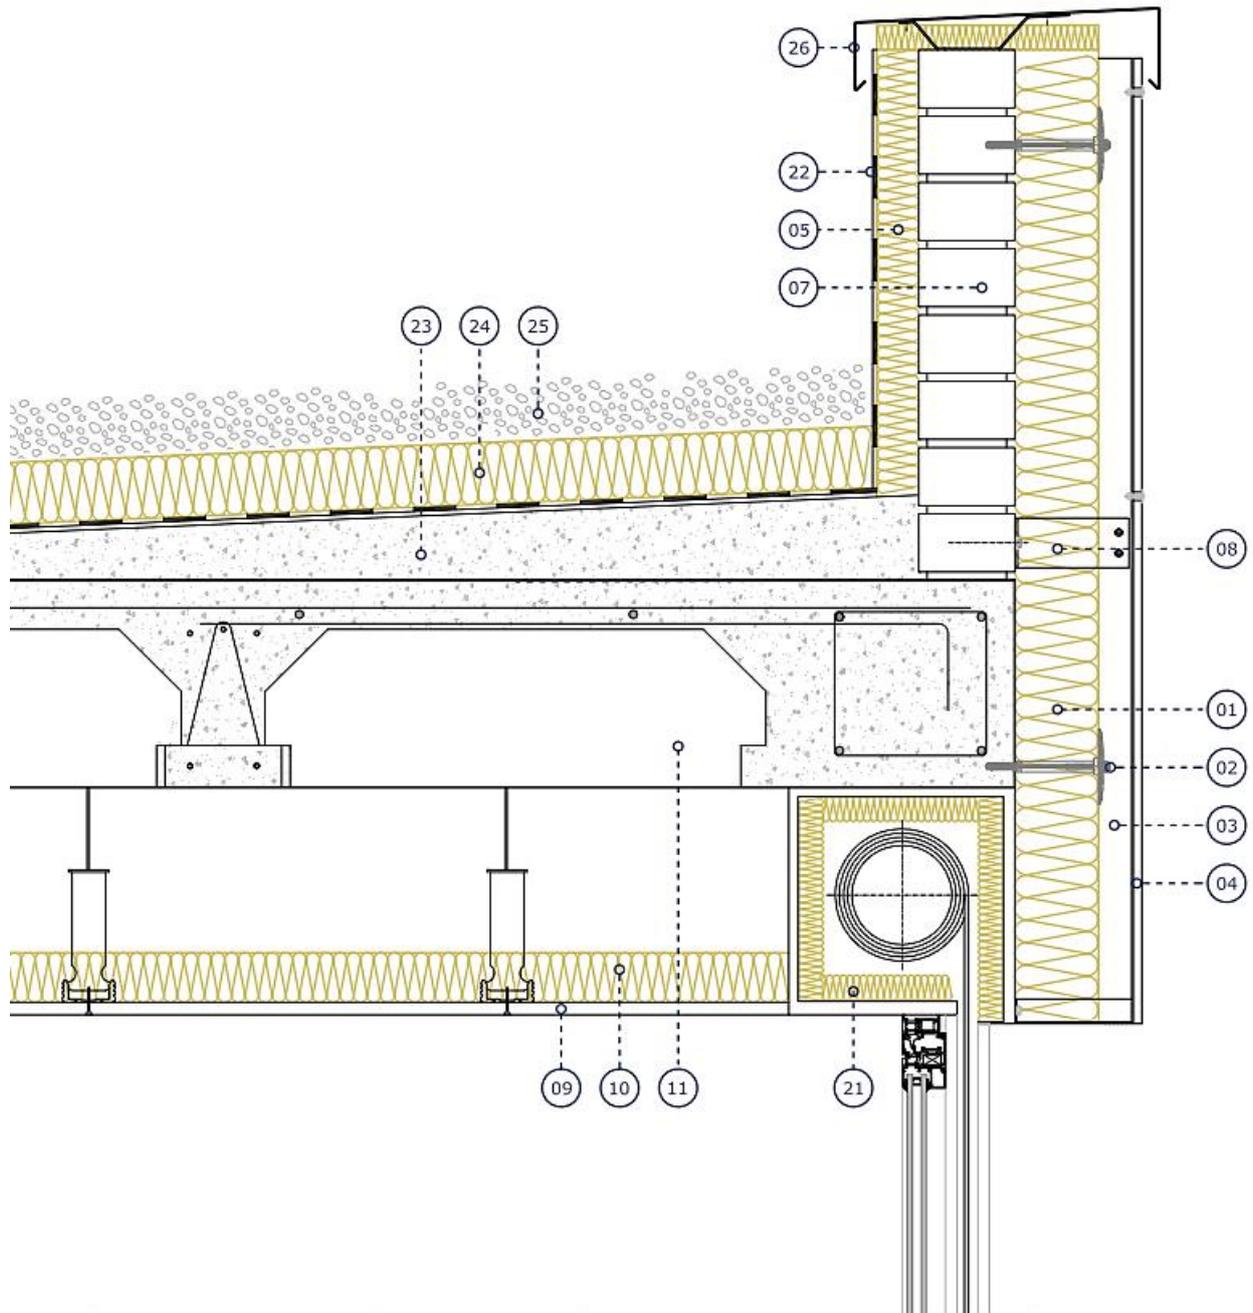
Fachada ligera con revestimiento de fachada ventilada.
